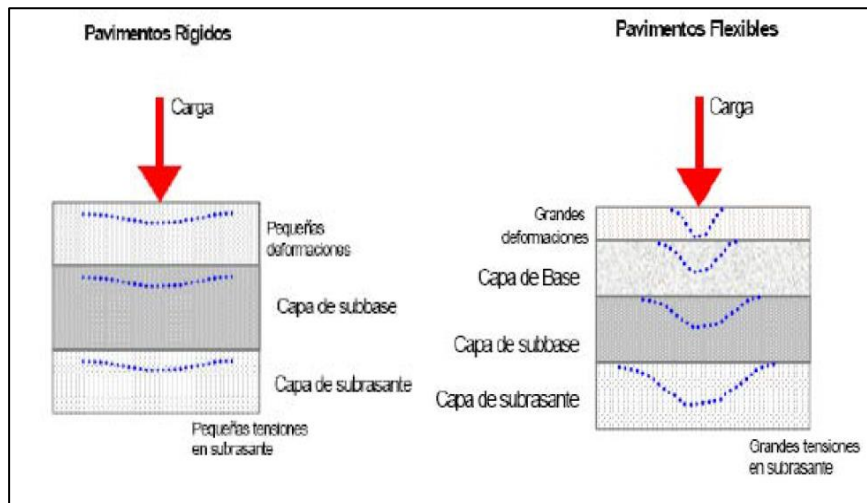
Deterioros en pavimentos flexibles y rígidos
